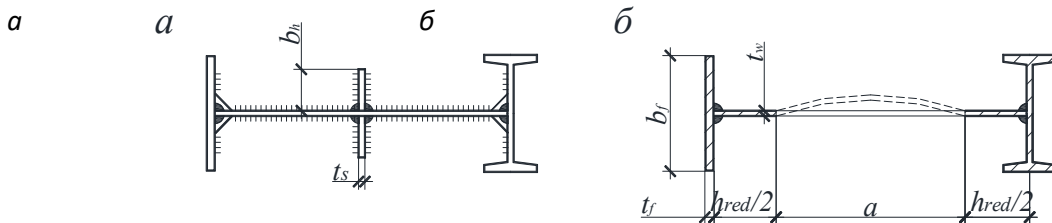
К подбору сечения стержня сплошной колонны:
